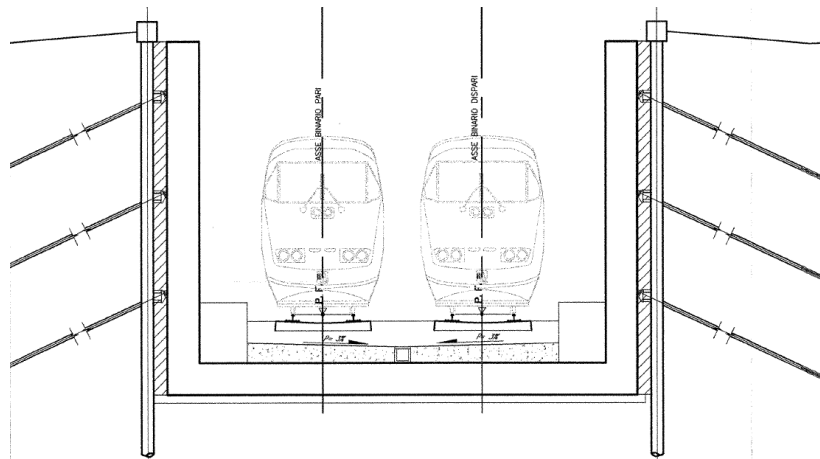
Raggiungimento del fondo scavo ed esecuzione delle opere di regolarizzazione ed impermeabilizzazione
